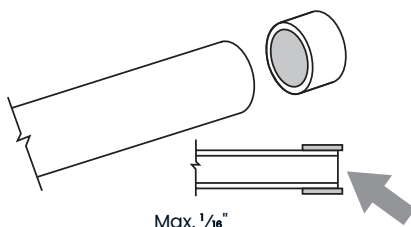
Glisser la bague dilatée sur l'extrémité du tuyau
